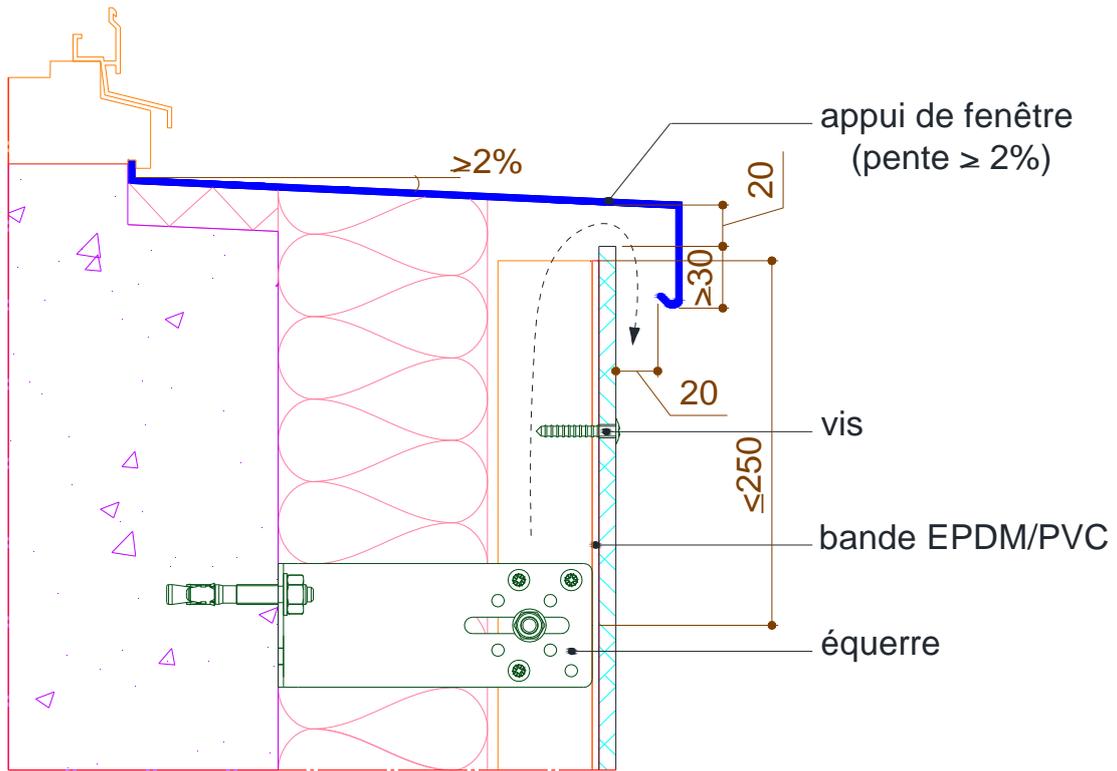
Détail appuis de baie sur ossature bois (cote en mm)
